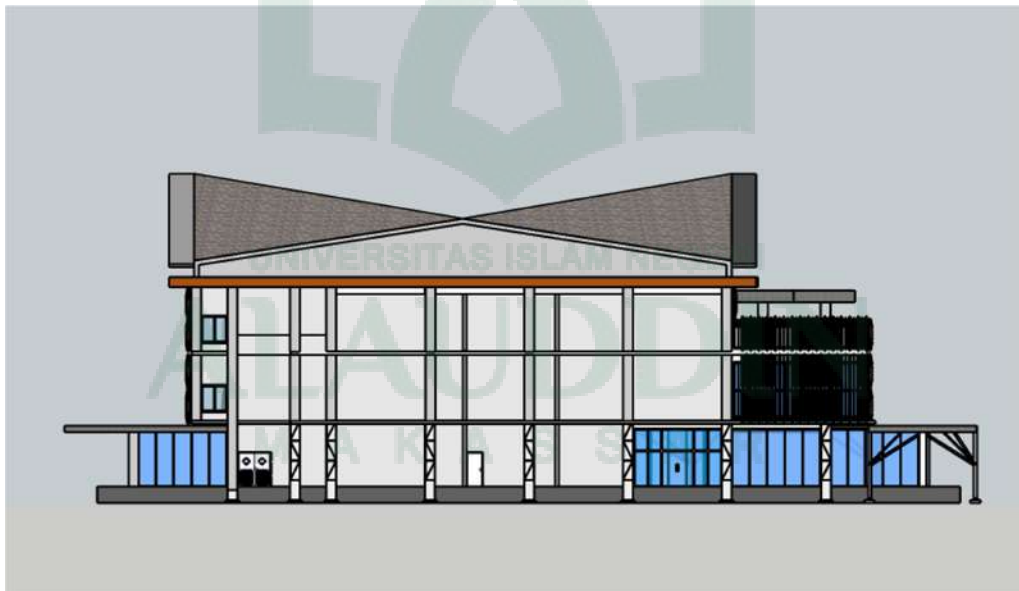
Tampilan Samping Kanan Bangunan Utama
